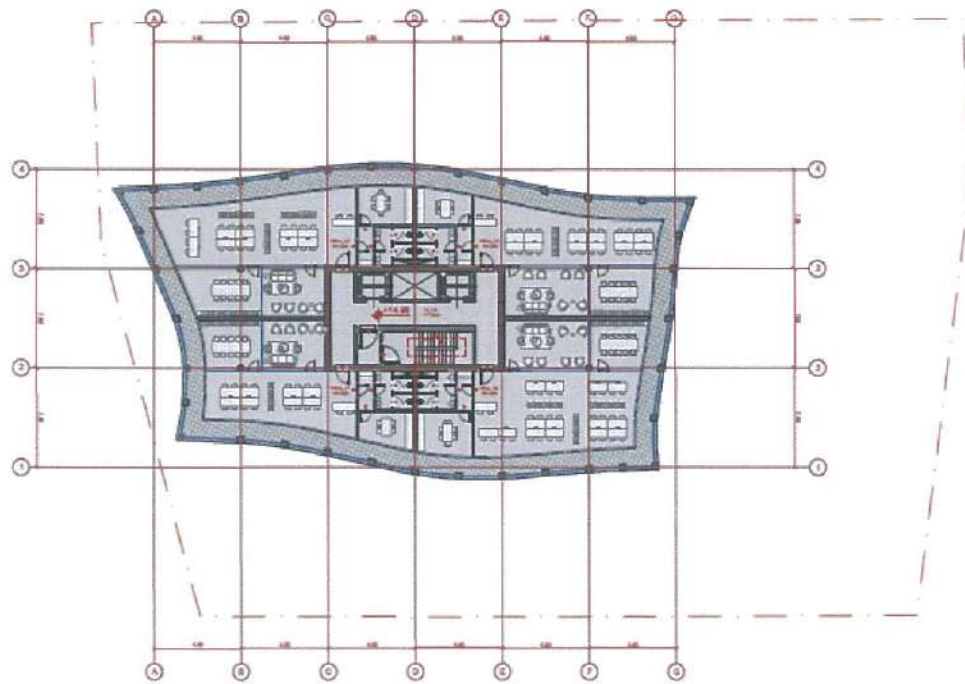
Planimetria e katit 3, në kuotën +14.96 SIP 889 m²
